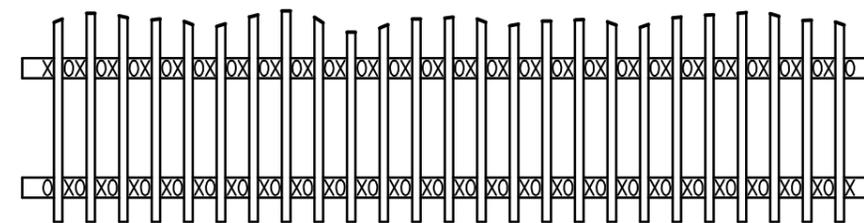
MODÈLE DE SOUDURE DU SOUS-PLANCHER
